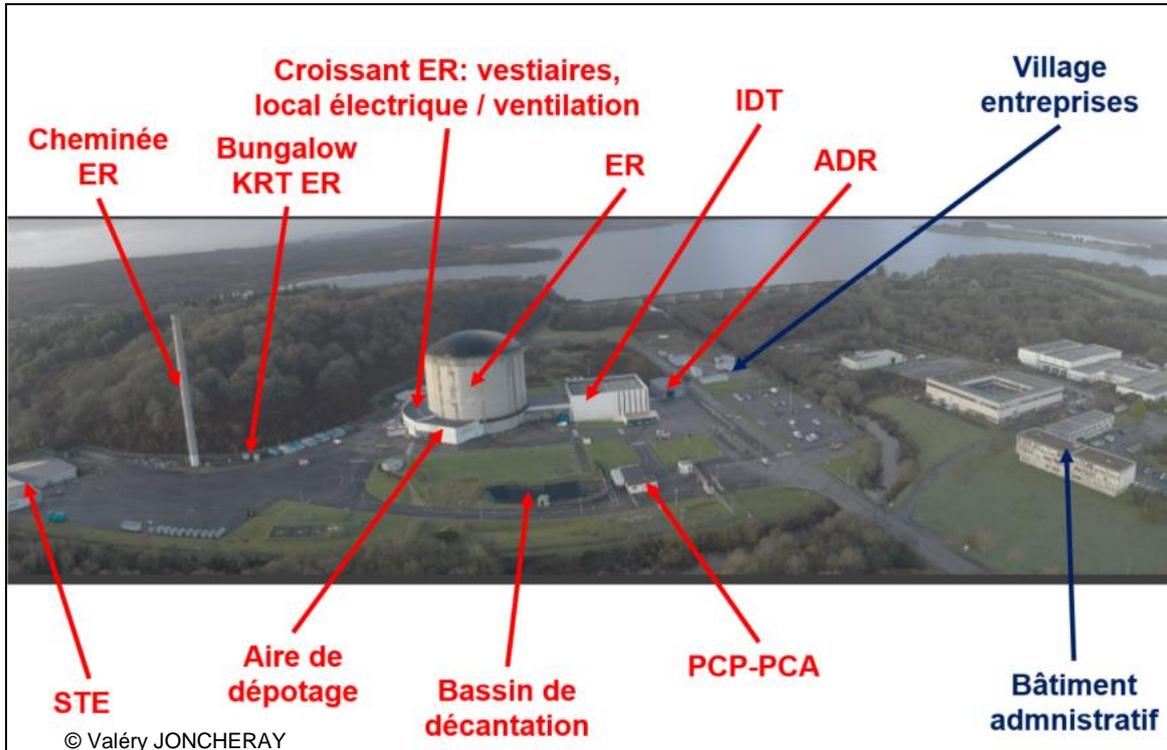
Installations situées sur le Site des Monts d'Arrée (année 2020)
